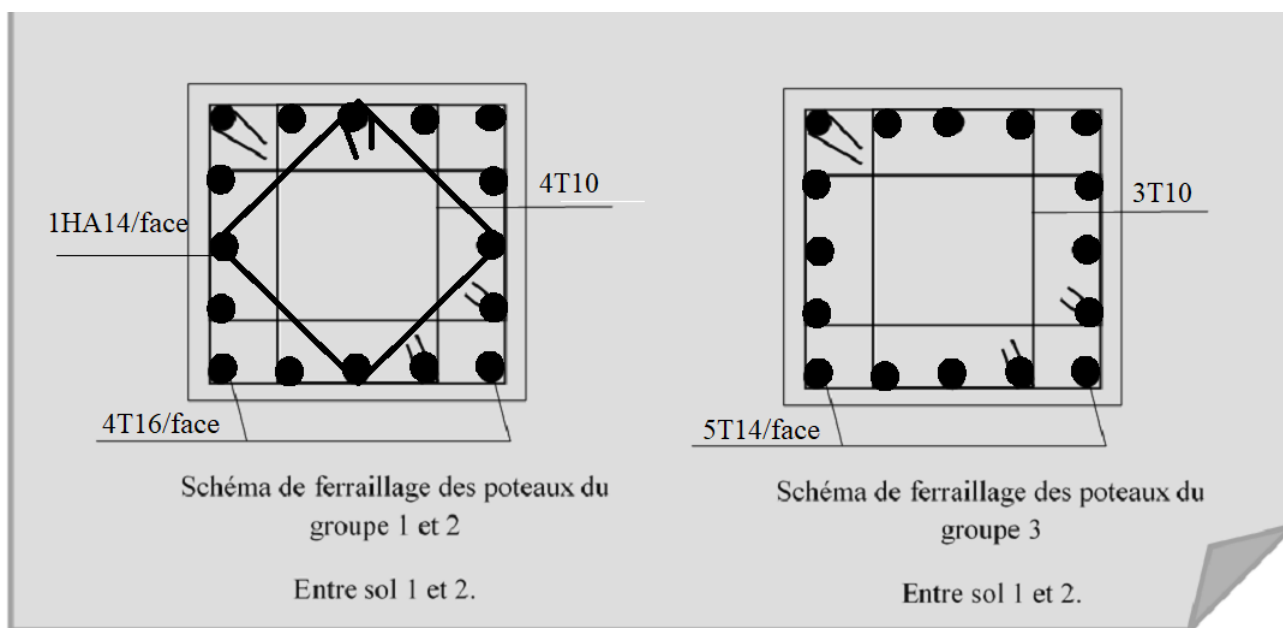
Schémas de ferrailage des poteaux entresols 1 et 2
